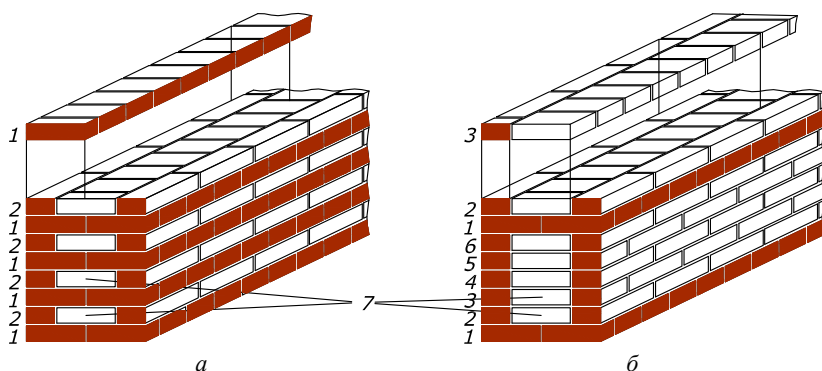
Системы перевязки при кладке стен толщиной в 2 кирпича:
